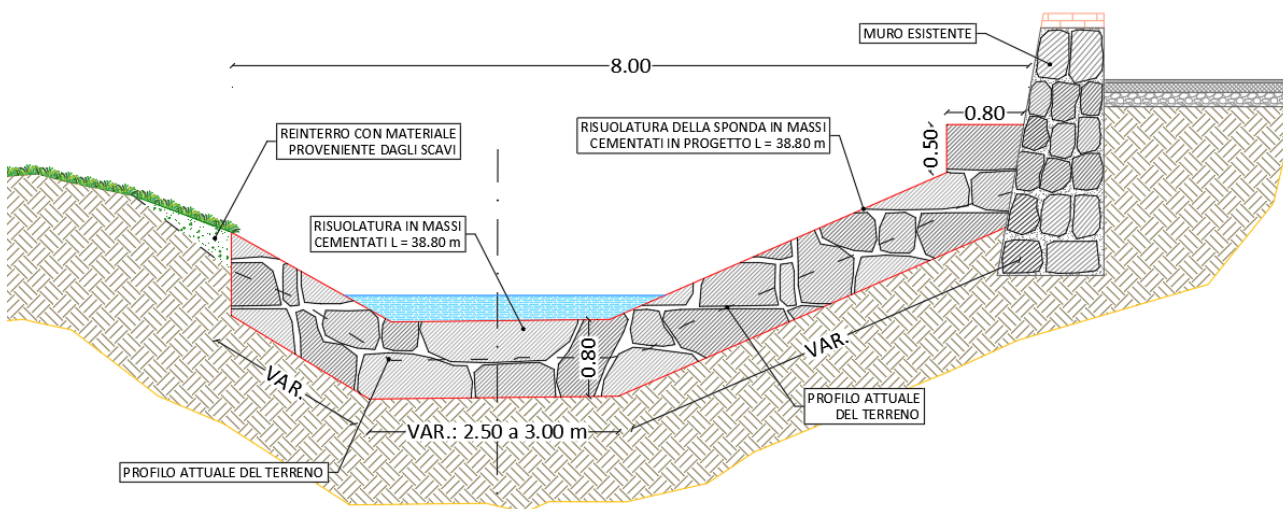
Sezione tipo di progetto relativa all'intervento D
